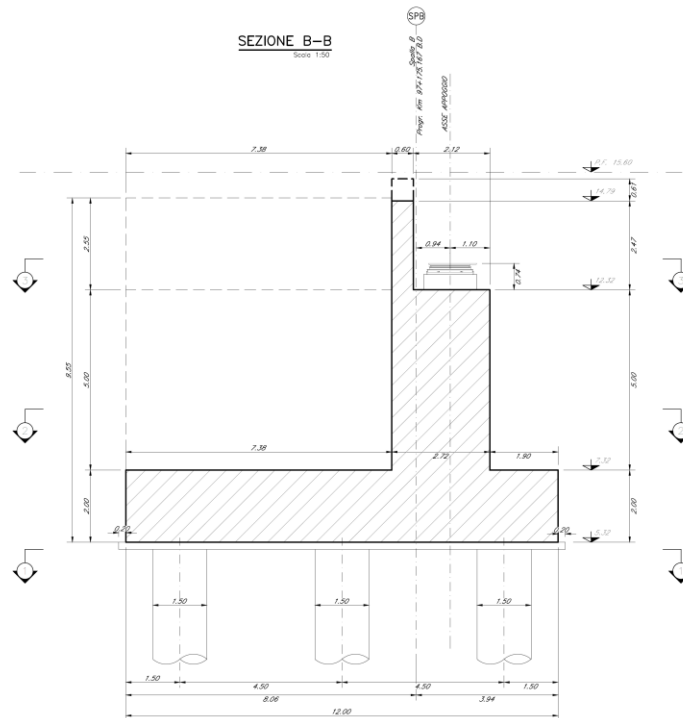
Sezione longitudinale B-B della spalla B – Lato Ventimiglia
